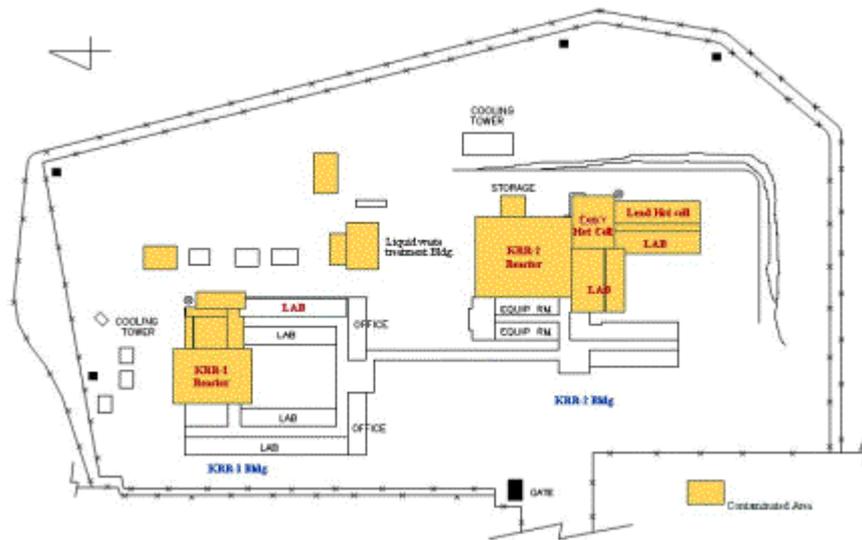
韓國 KRR-1&2 廠區平面示意圖
